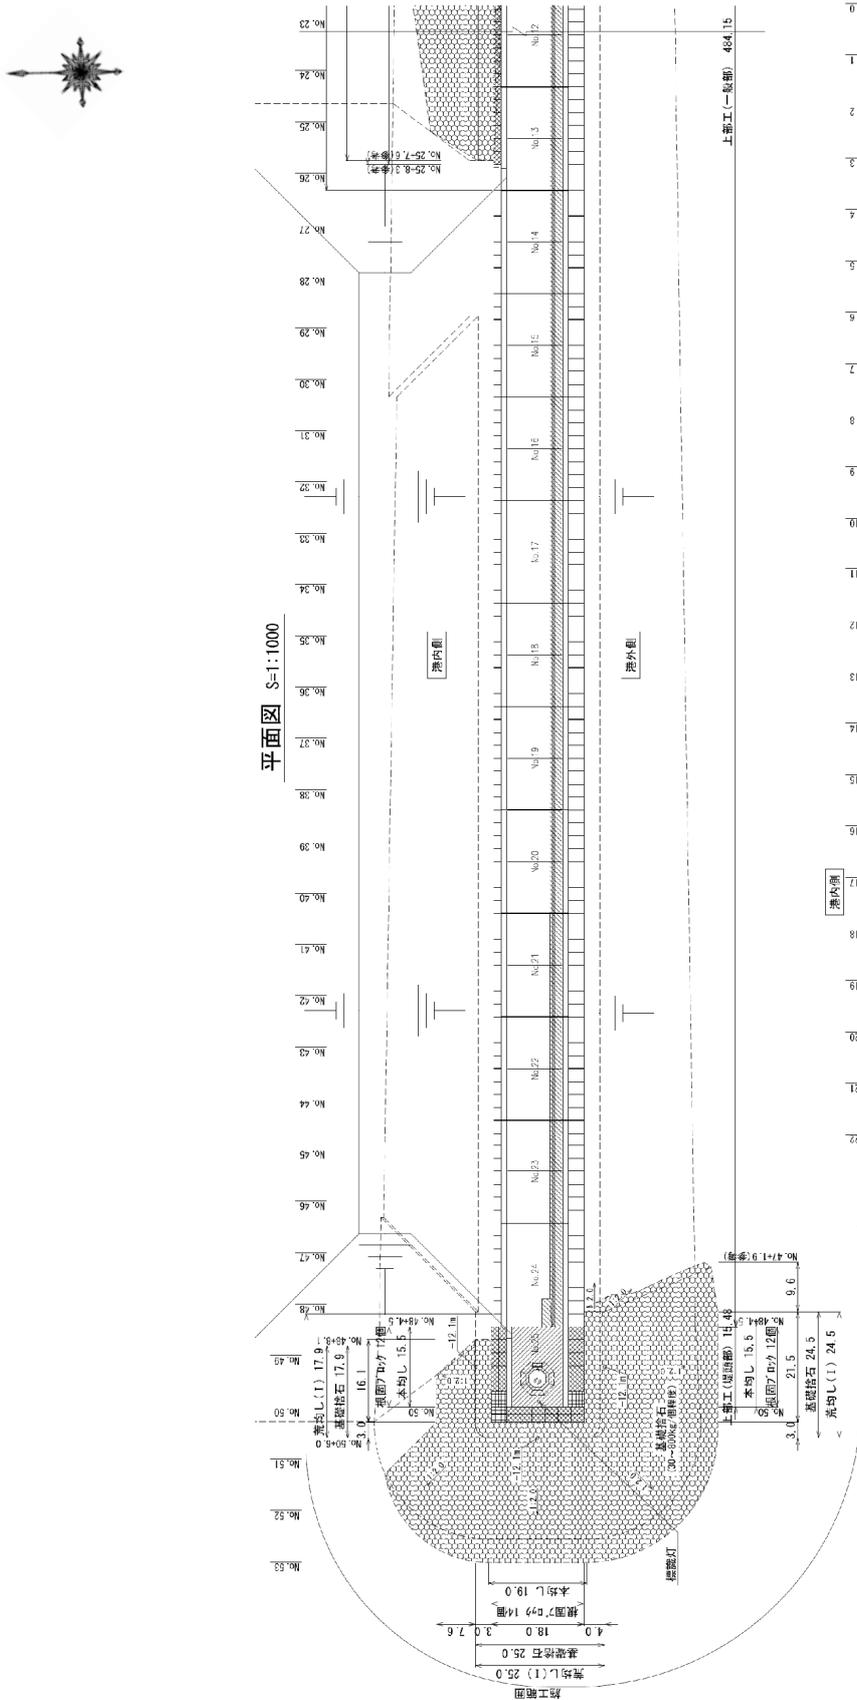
No.1 常陸那珂港区_北防波堤平面図① (復旧後)
